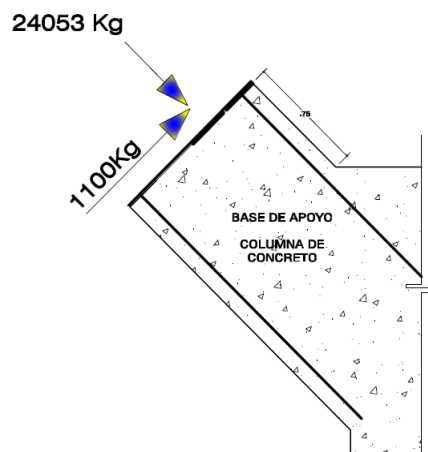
Cargas actuantes sobre el elemento de apoyo.
